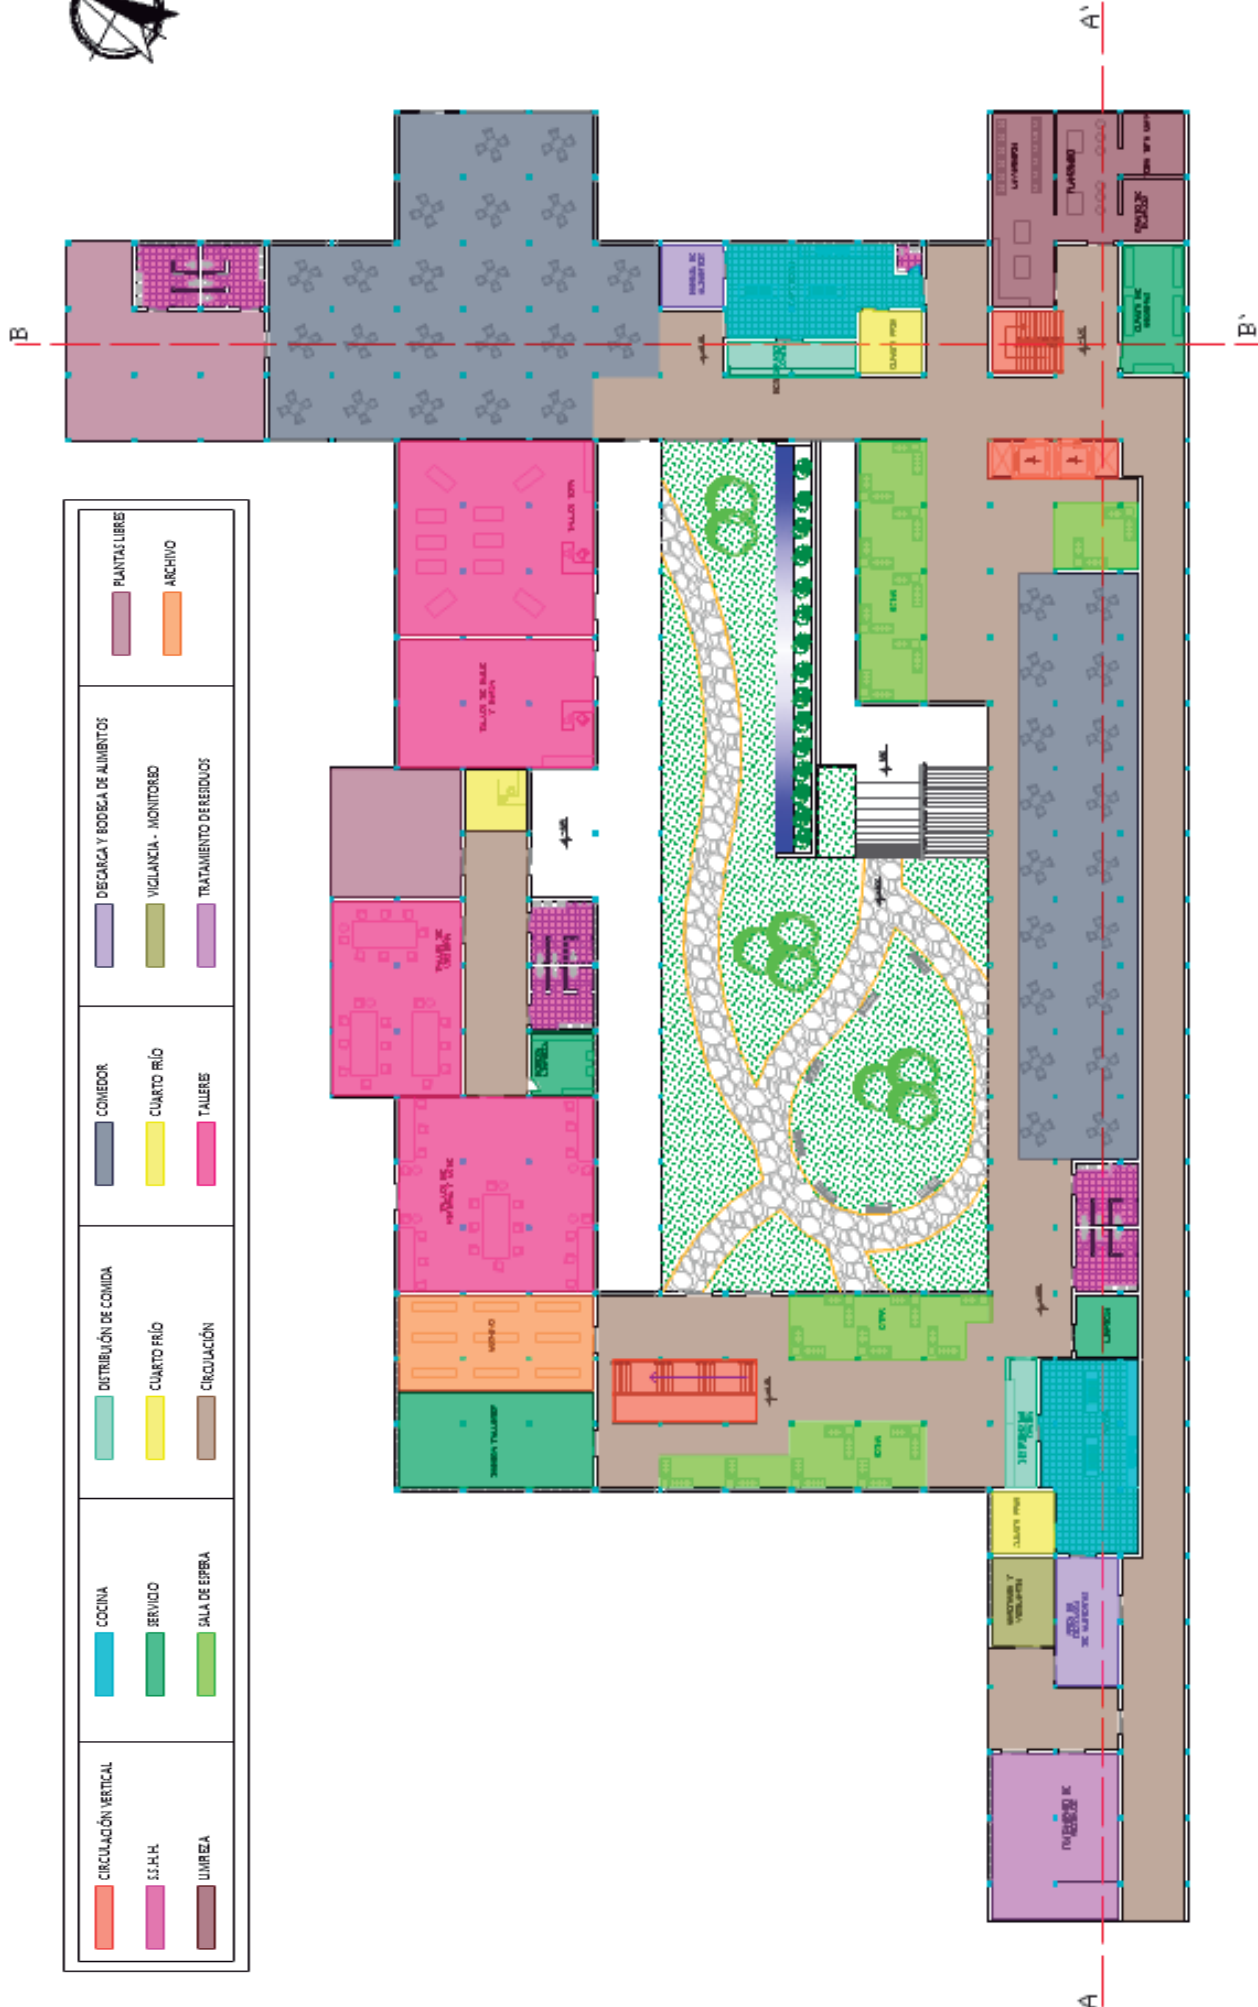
ZONIFICACIÓN SEGUNDA PLANTA
